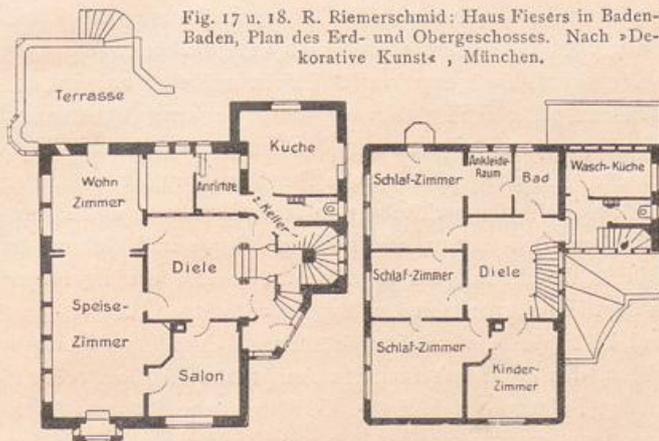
u. 18. R. Riemerschmid: Haus Fiesers in Baden-Baden, Plan des Erd- und Obergeschosses. Nach »Decorative Kunst«, München.
